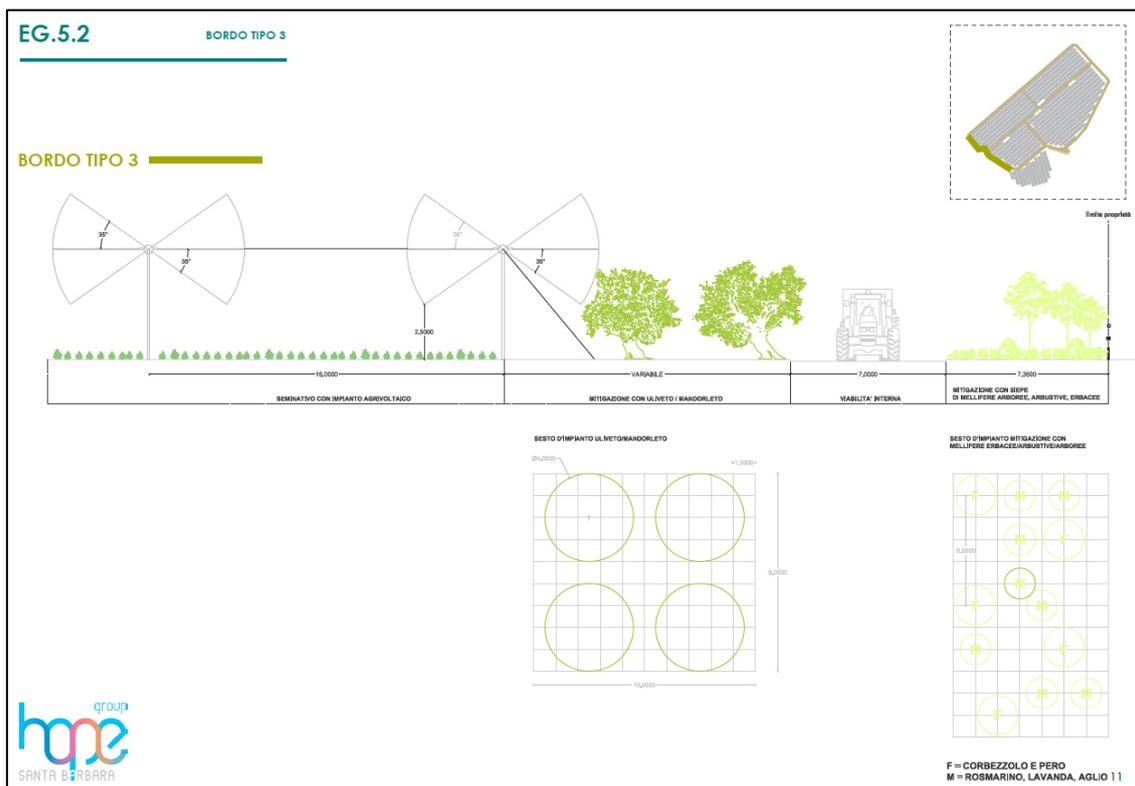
Schema mitigazione dall'esterno all'interno: piante mellifere – strada di viabilità interna – mitigazione del tirante con colture da frutto (olivo o mandorlo)
